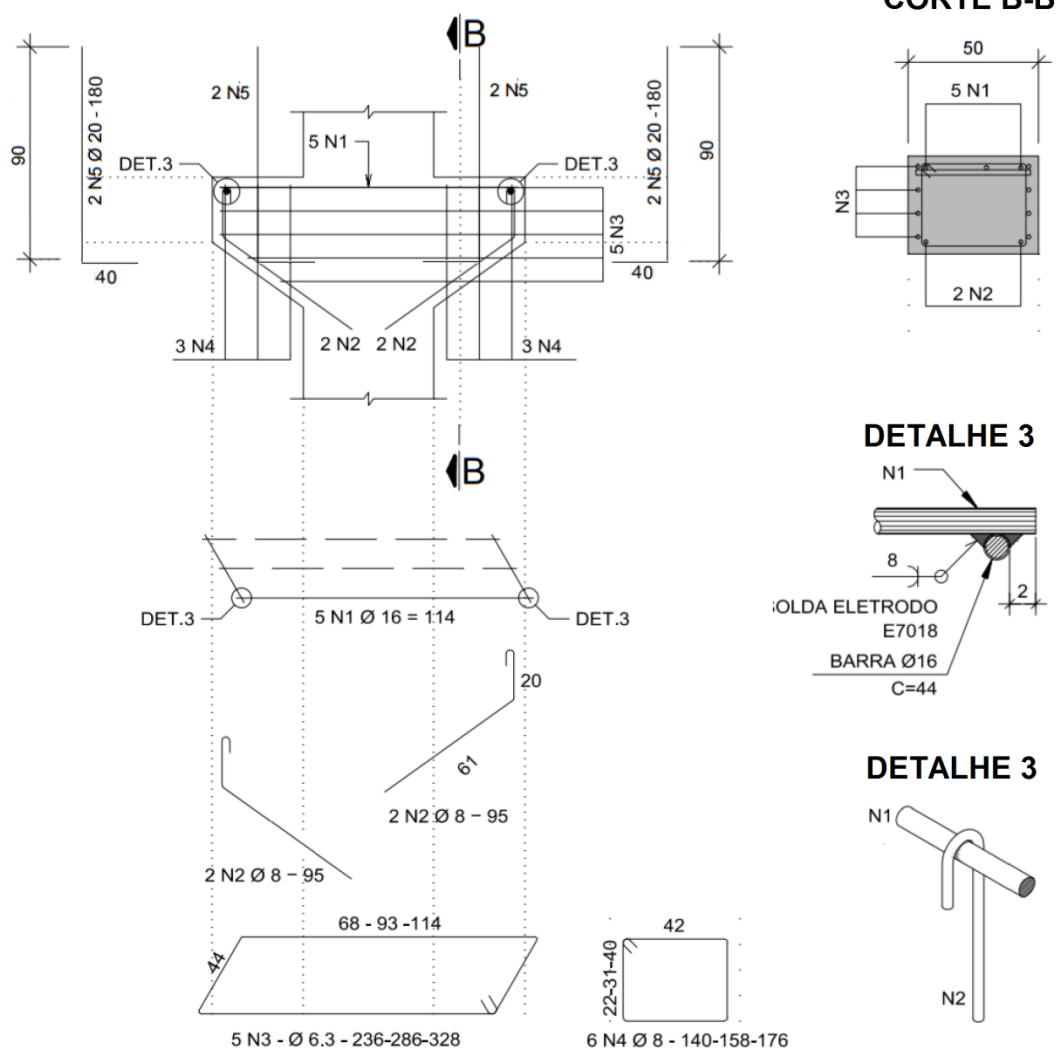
Planta de forma e ferragem de pilares com consolos e chumbador
